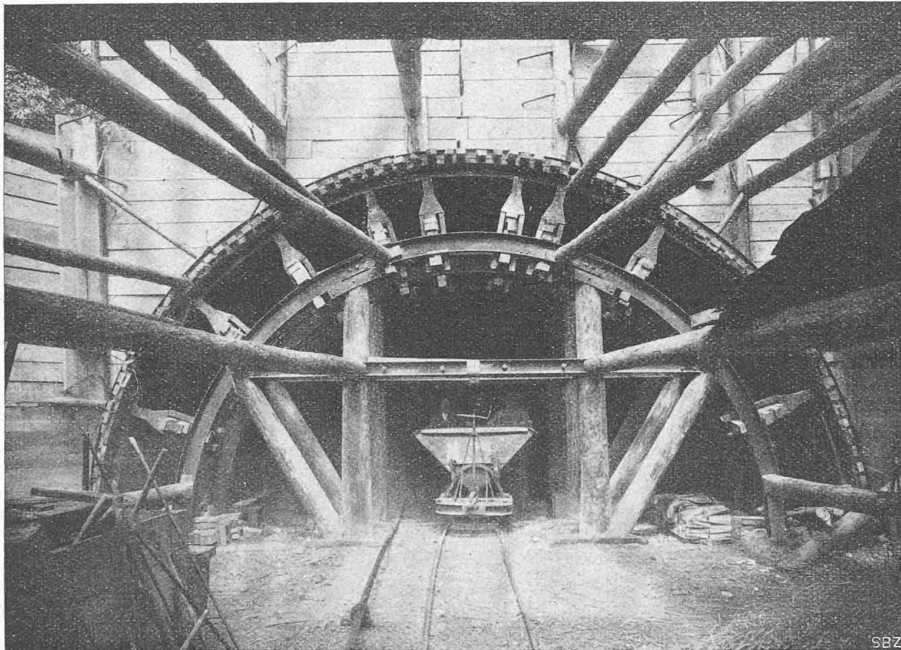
Ausschachtung an Tunnelmündung mit Kunz'scher Rüstung.
